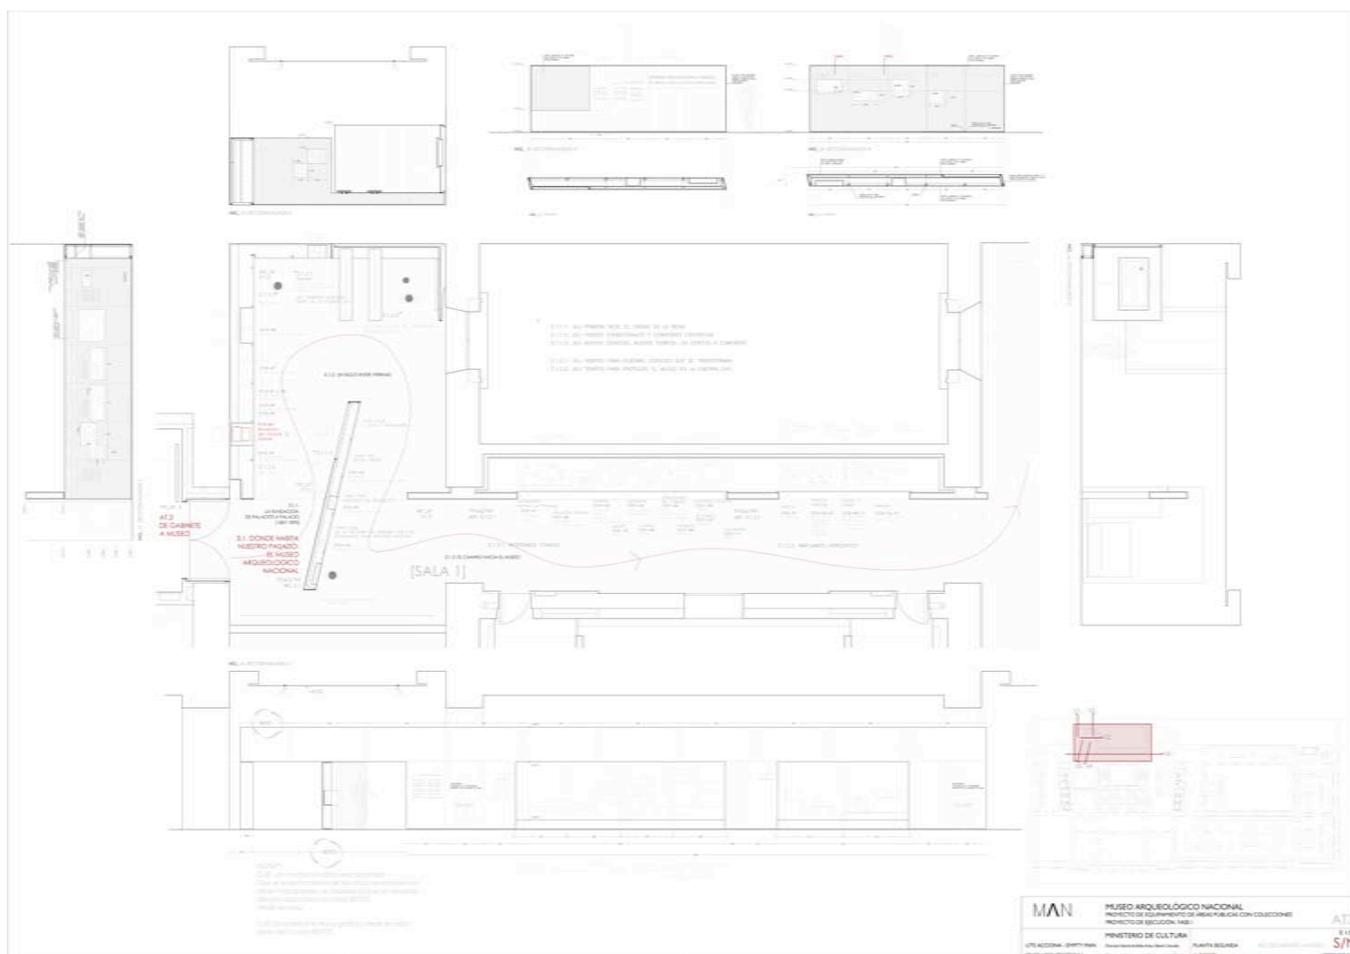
Planos y alzados del módulo expositivo «Donde habita nuestro pasado...». Proyecto de equipamiento de Áreas públicas con colecciones. Proyecto de ejecución. Fase 1. Planta Segunda. AT3. Alzados Donde habita nuestro pasado. UTE Acciona-Empty. MAN. Frade Arquitectos.
